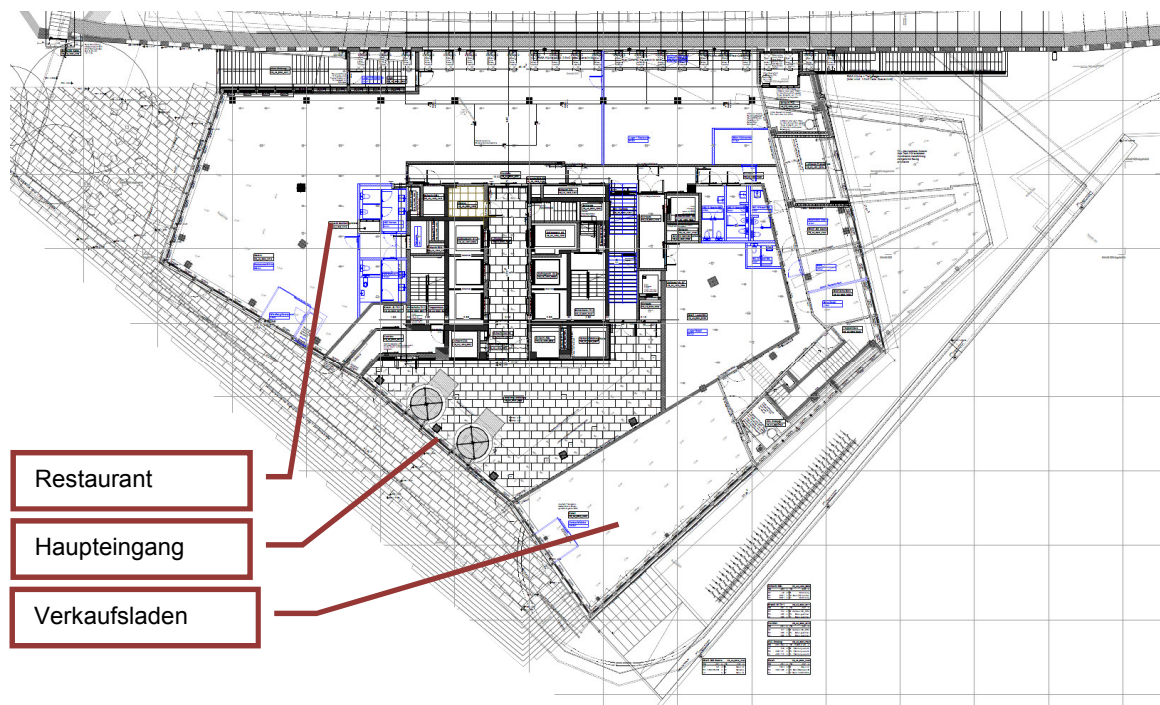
Grundriss Erdgeschoss mit Restaurant, Eingang und Verkaufsladen
